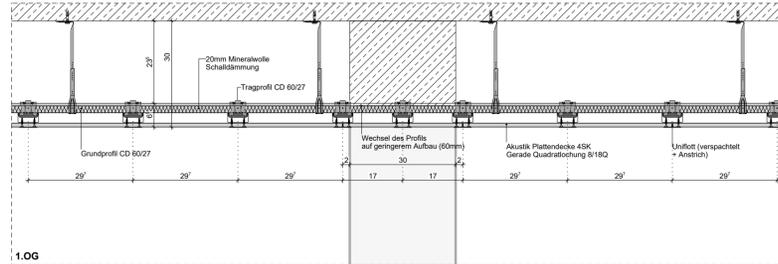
Übergang neue Mitte zu Aufstockung Bestand
